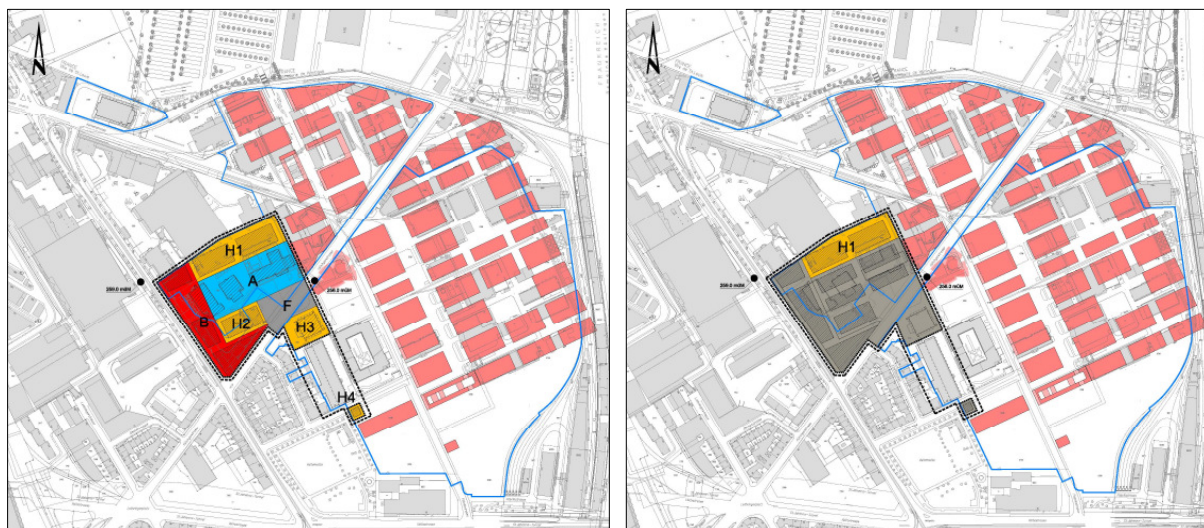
und 4: ursprünglicher und rechtskräftiger Bebauungsplan Hochhauszone Teil 1 (kein Massstab, Plan genordet)
